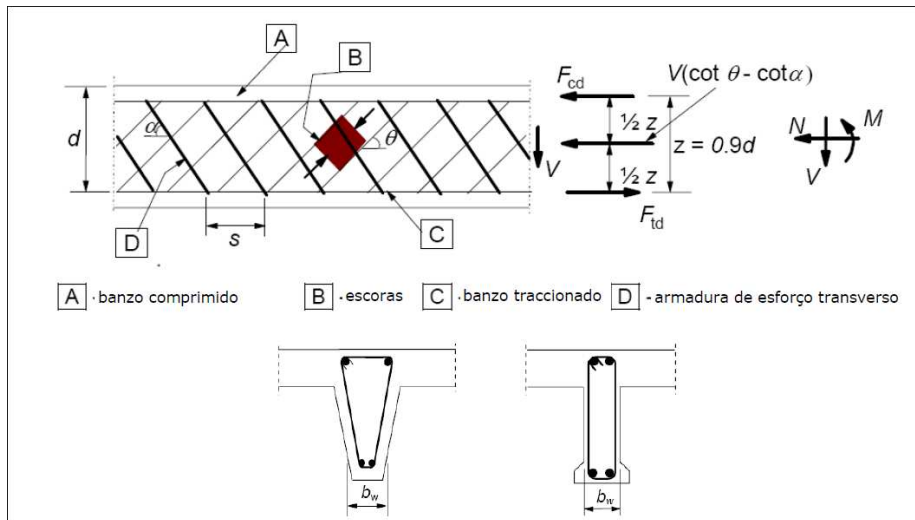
Módulo de treliça e notações para elementos com armadura de esforço transverso
